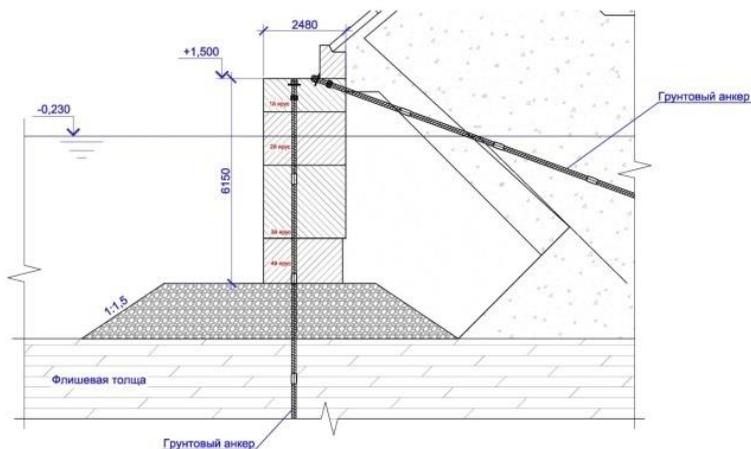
Усиление сооружения из массивовой кладки грунтовыми анкерами
